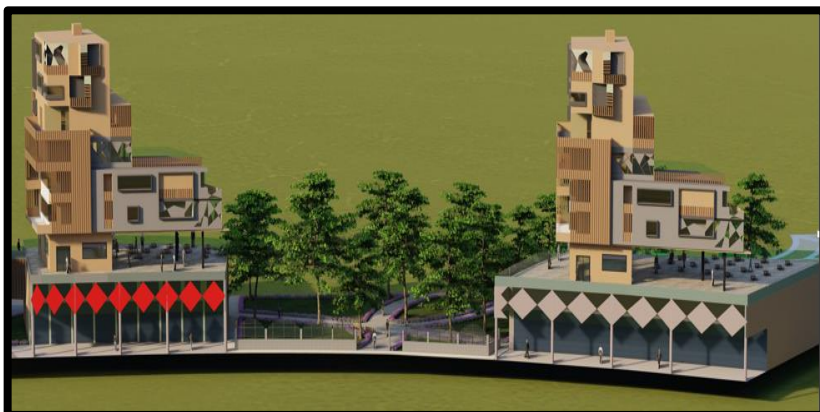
vue sur l'immeuble mixte au lieu du marché après l'intervention.
